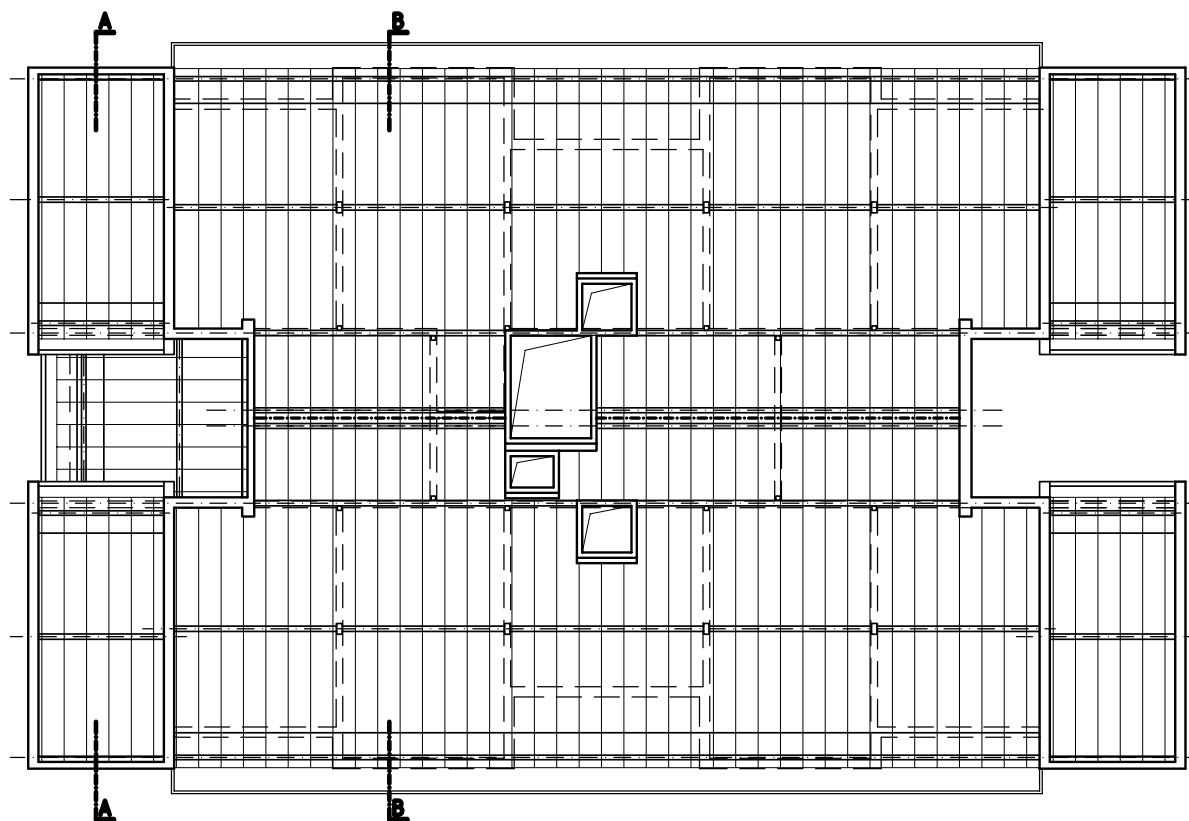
Pianta di una delle coperture degli edifici nello stato di progetto.
